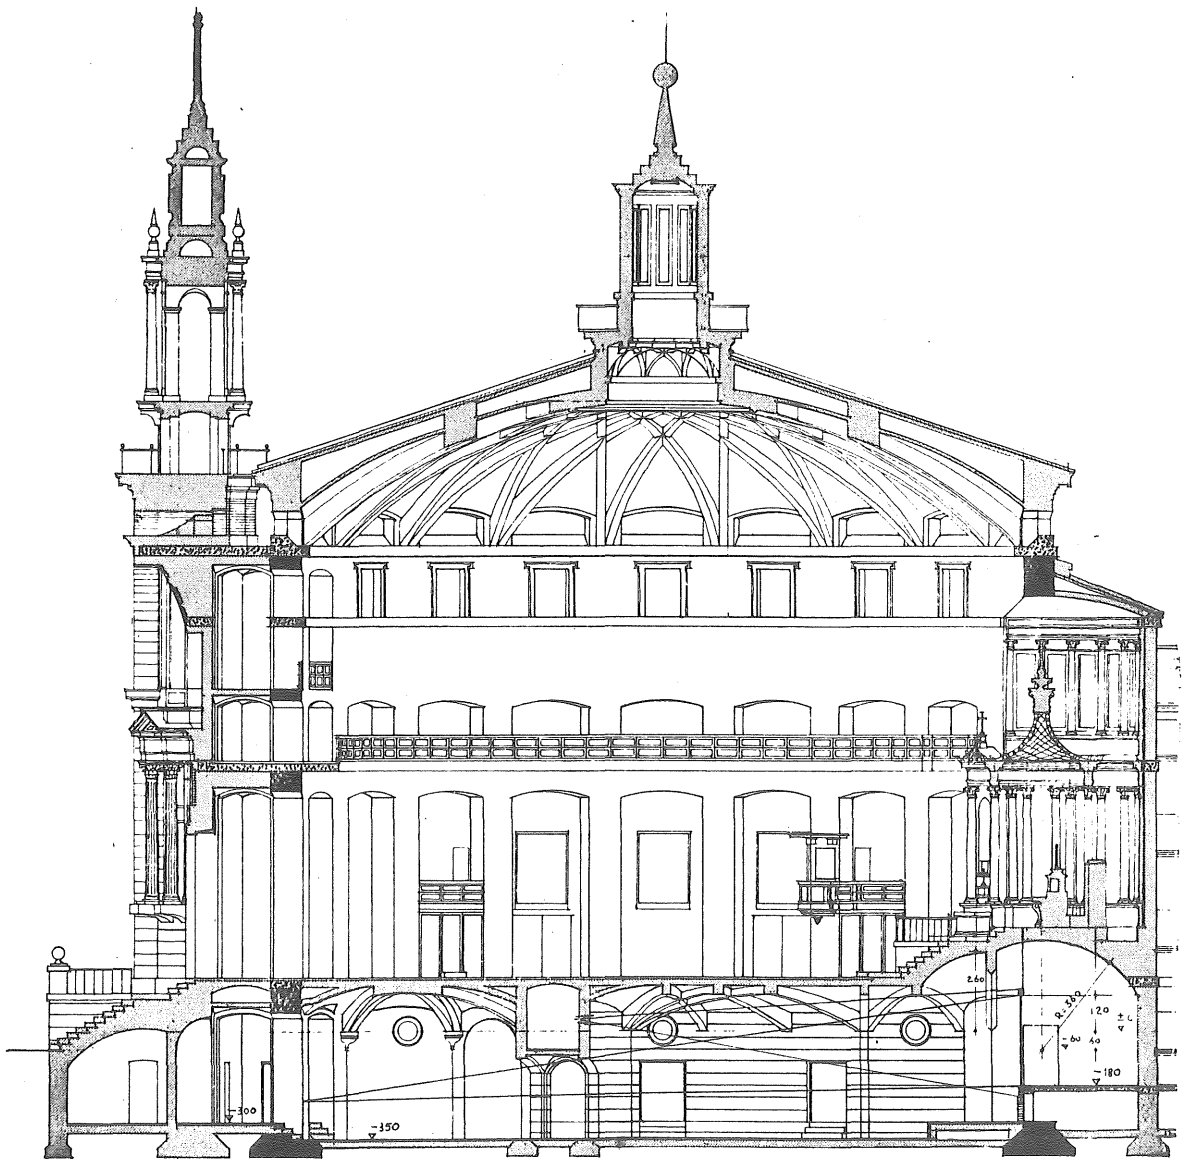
Sección longitudinal. Escala 1/252.
